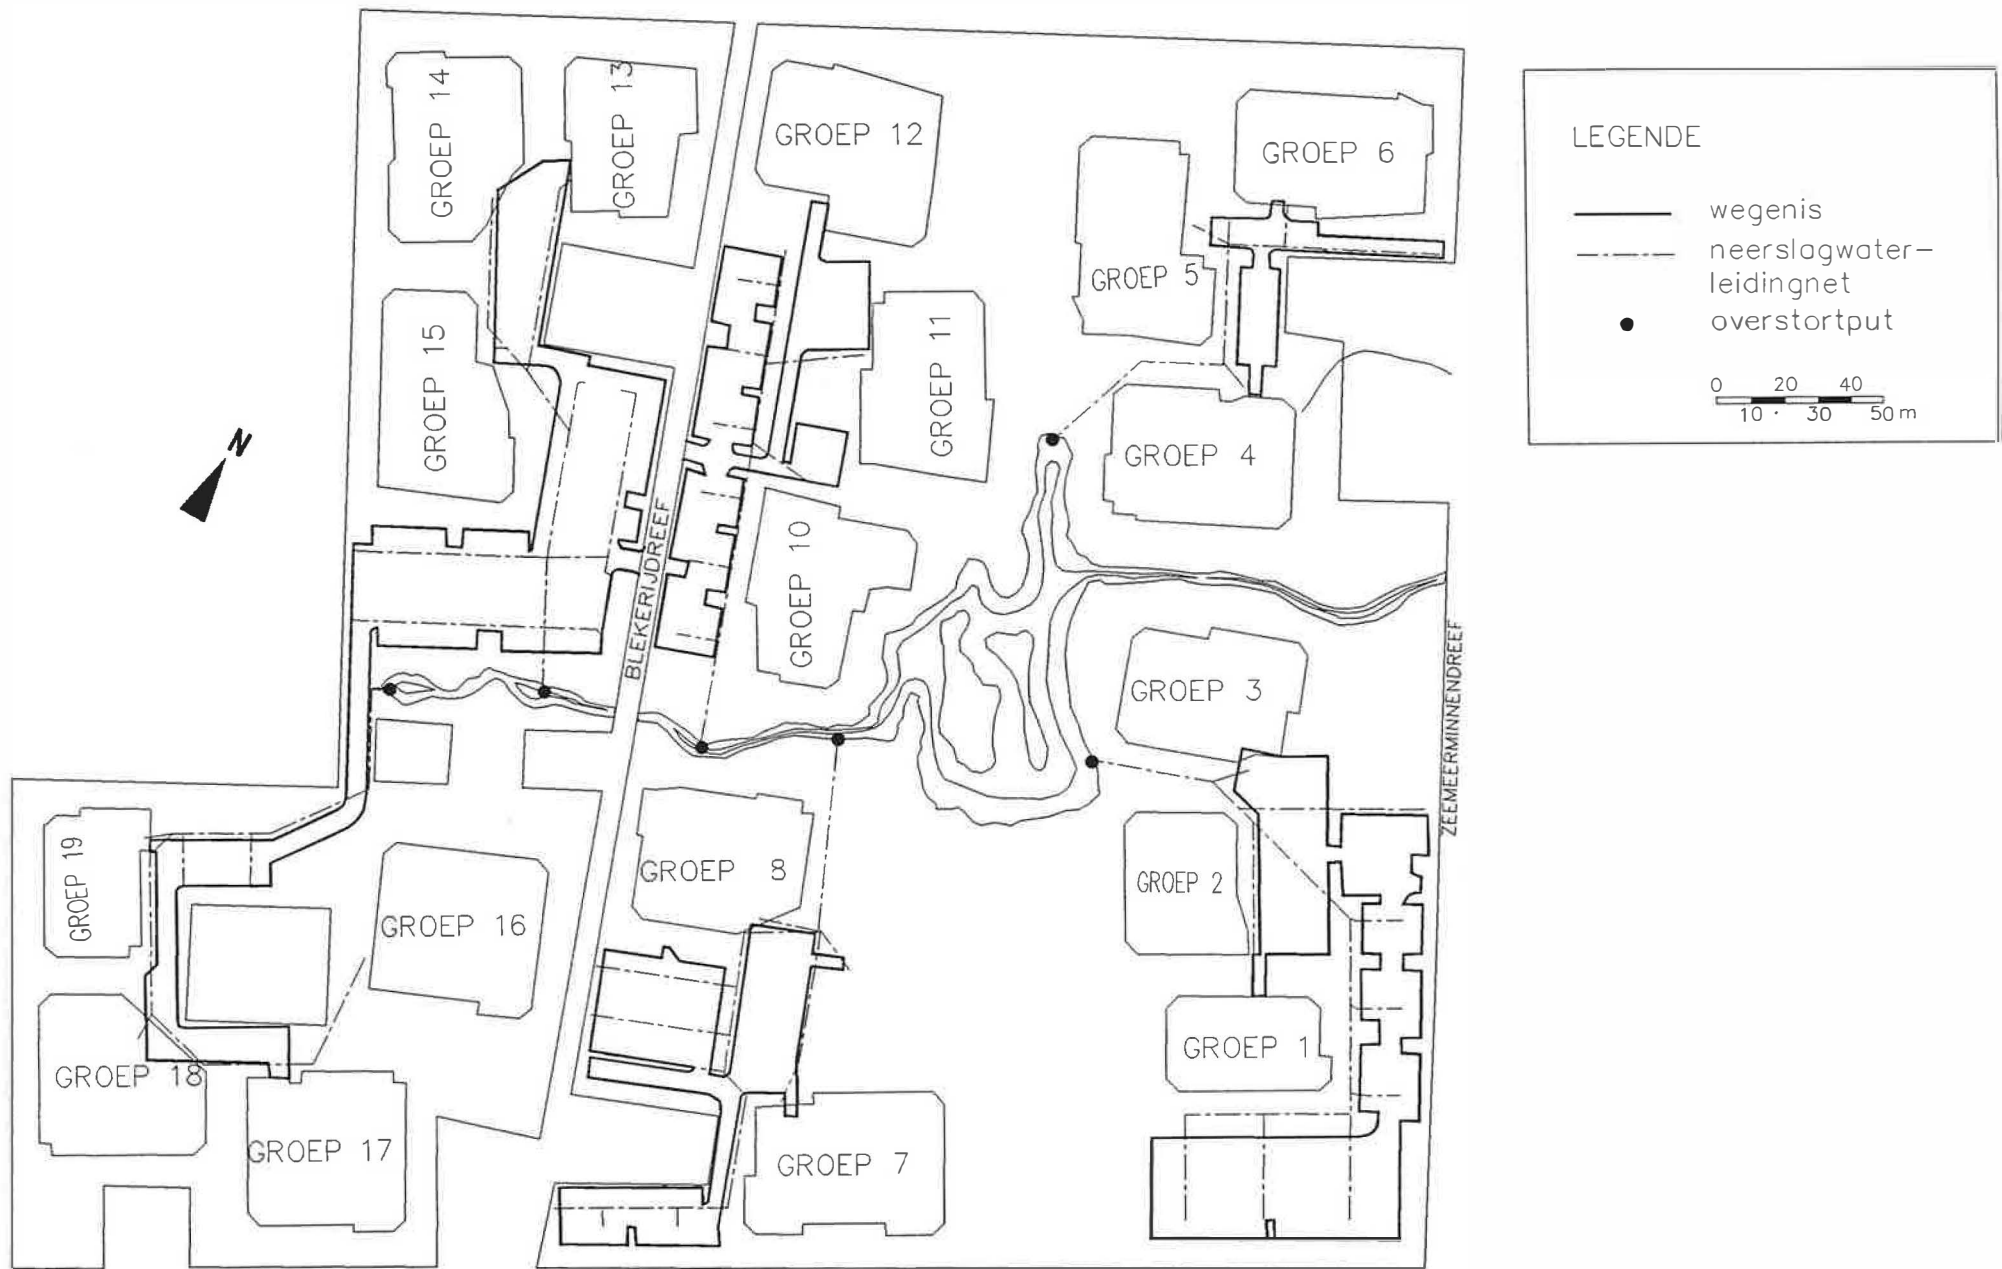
Algemeen plan van het projektgebied met de aanduiding van het neerslagwaterleidingsnet en de wegenis
